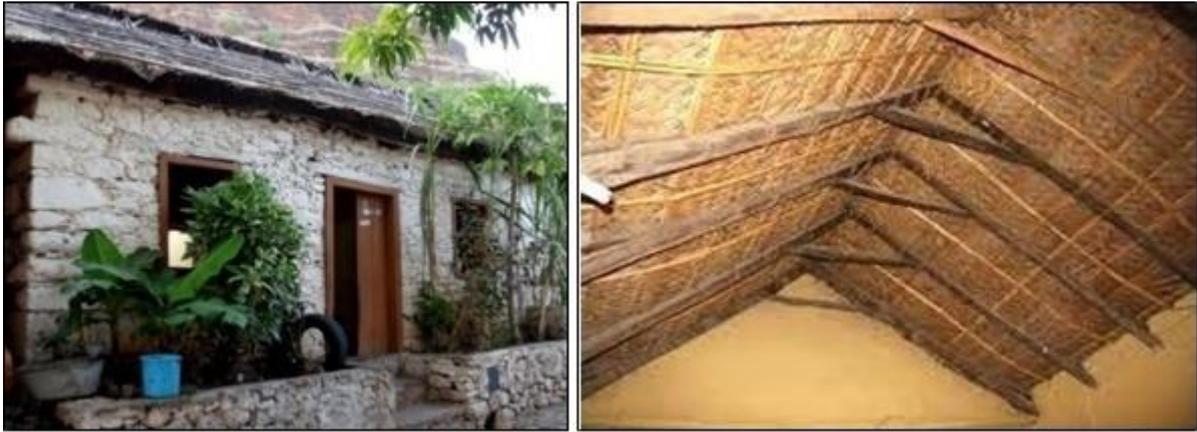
Fuente: "Construção e Arquitectura Sustentáveis em Cabo Verde"
